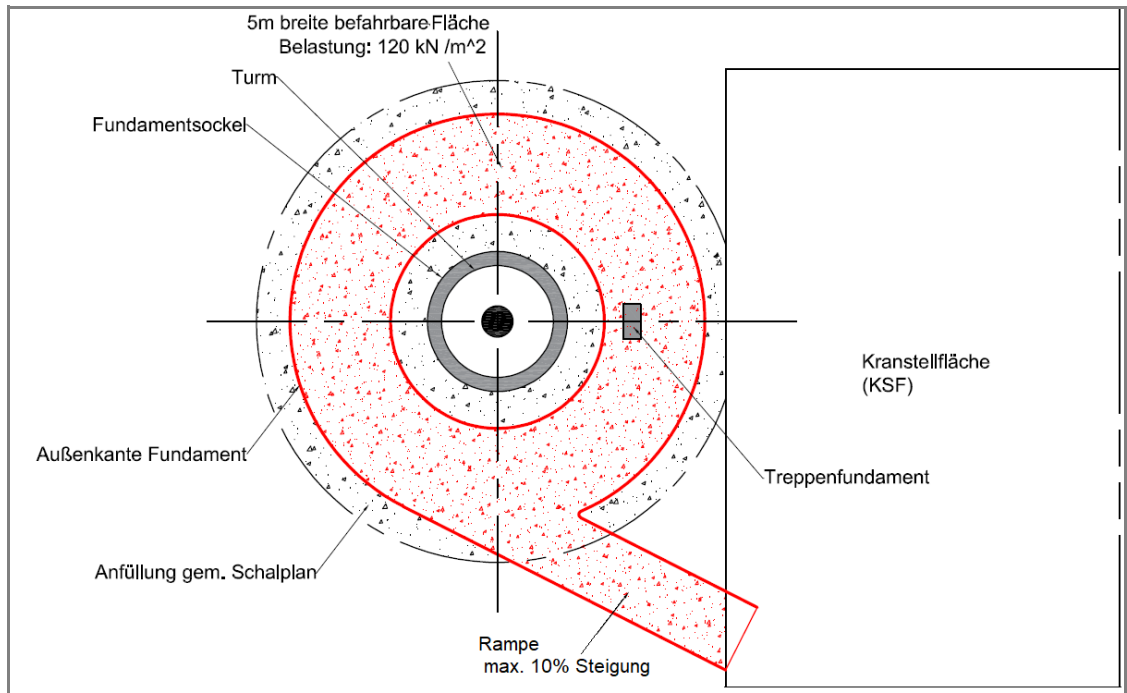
Fläche um den Turm in Draufsicht, Stahlrohrturm mit Außenflansch
